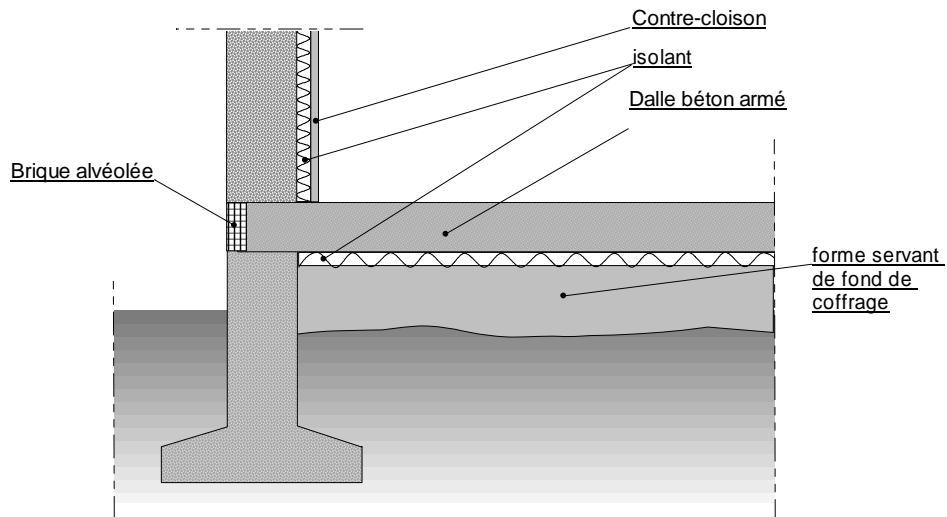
Dalle portée coulée sur terre-plein [Collignan and Sullerot, 2008].
